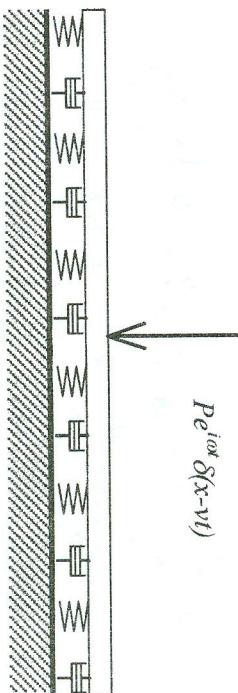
Расчётная схема пути с железнобетонными шпалами
